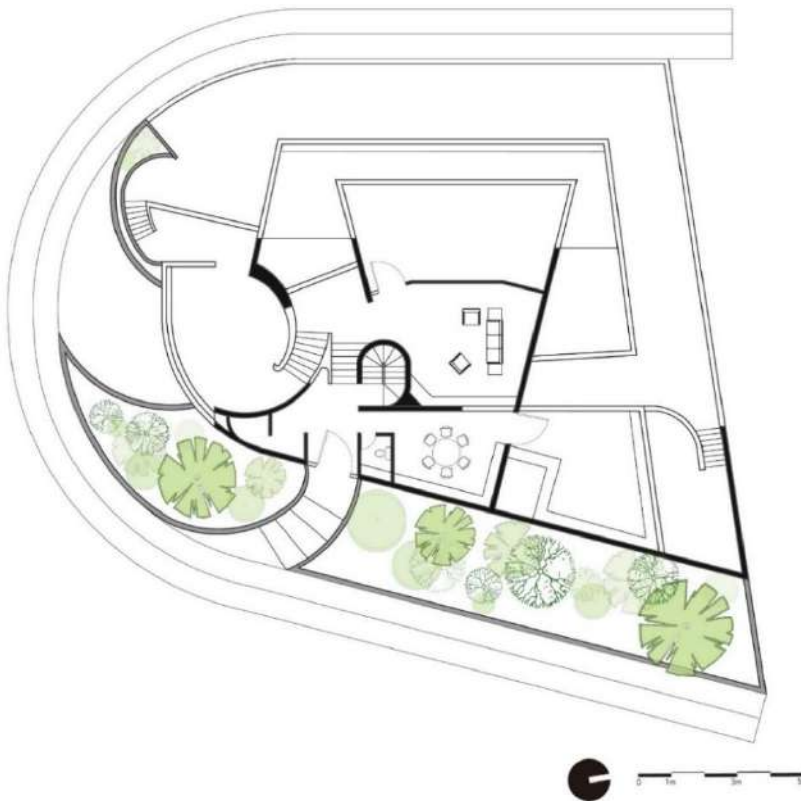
Planimetría Casa Calderón, segunda planta. Tomado de: Erazco, A. (2016). Edición: La Autora (2021).
